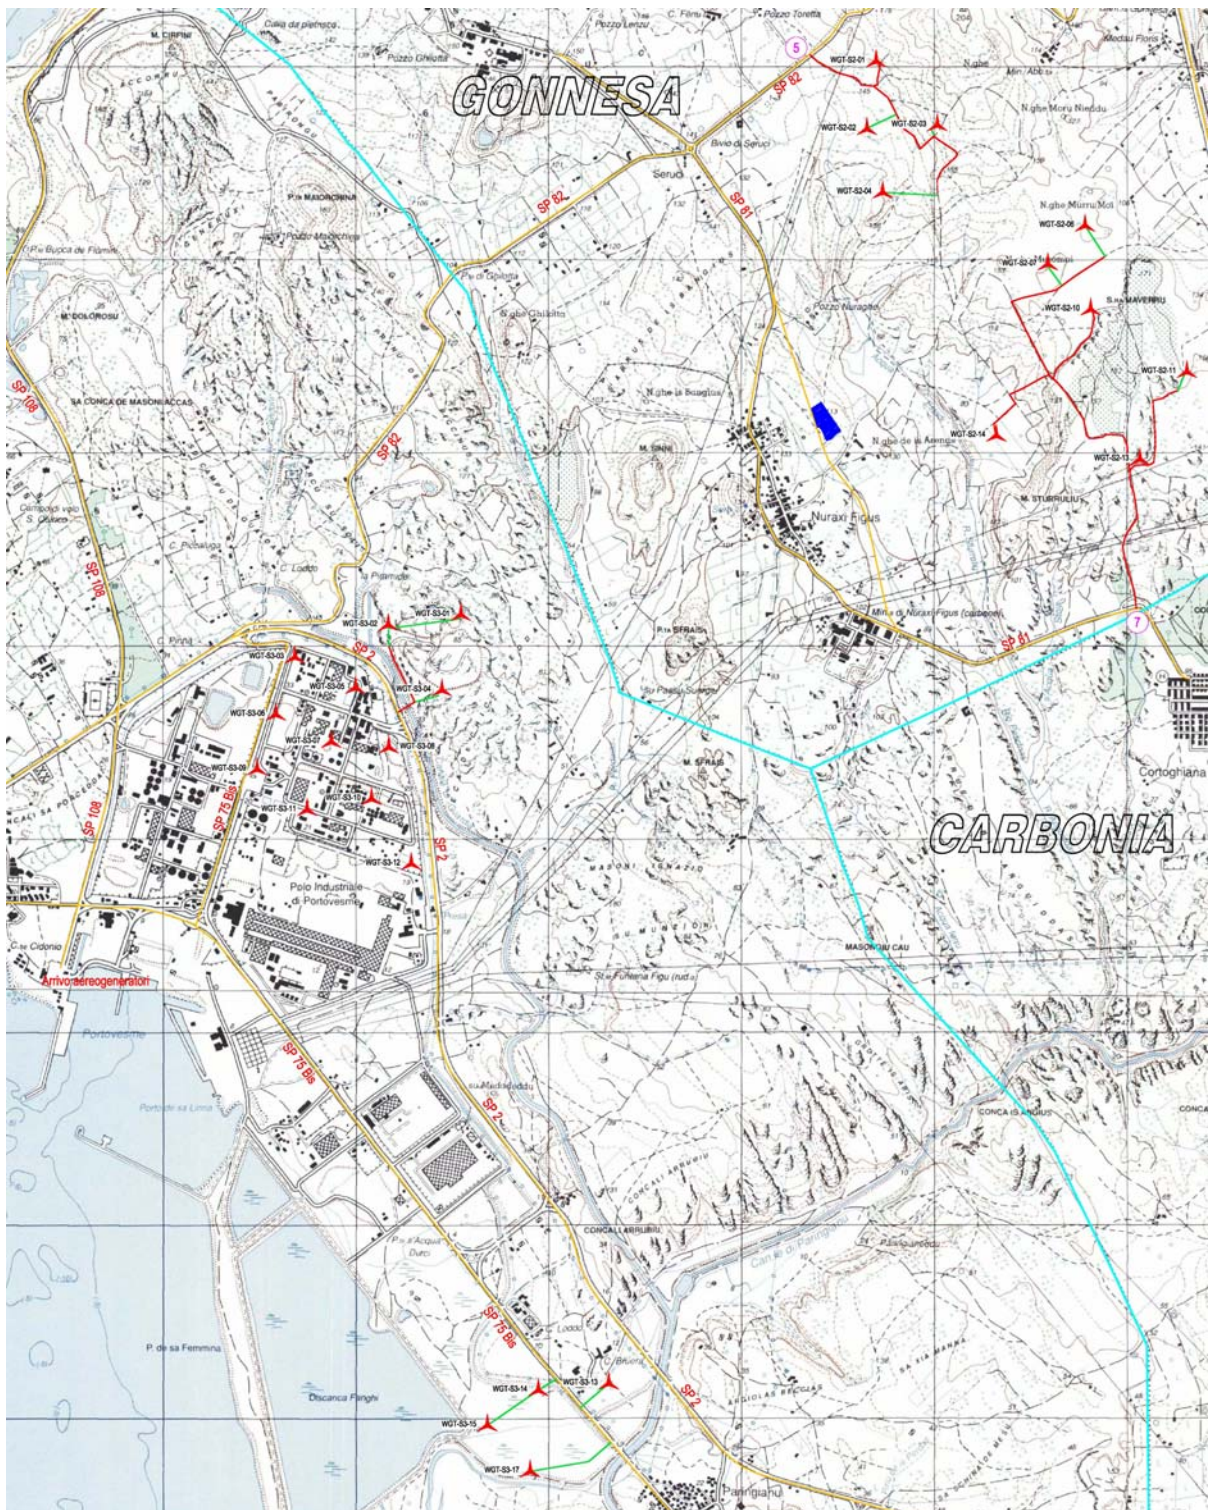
Planimetria generale con viabilità (adattamento da tavola in scala 1: 10.000)
